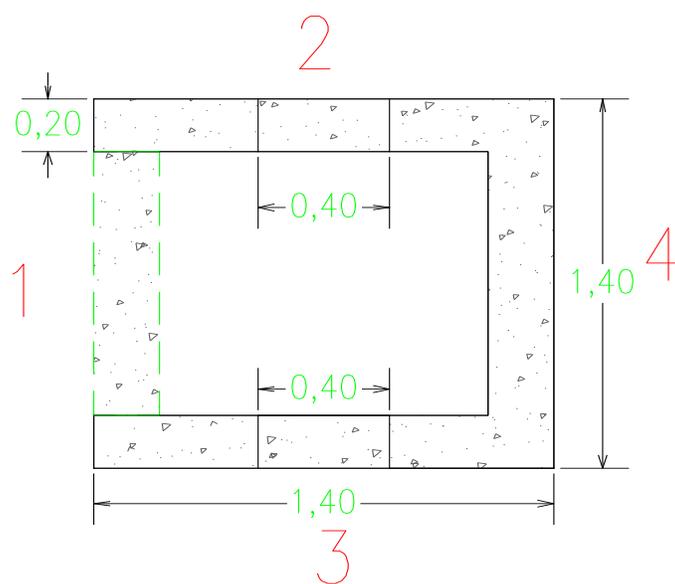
Vista superior alcantarilla tipo cajón descole K1+330 (Fuente: Pasante)
